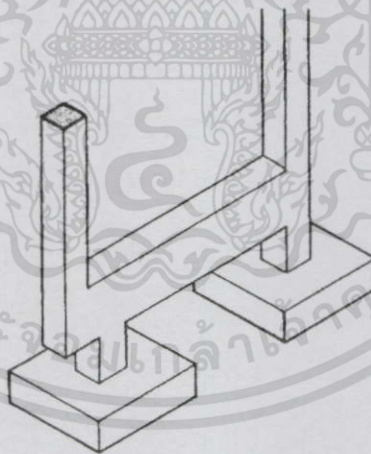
แสดง ฐานรากแผ่แบบยื่นหรือยึดร่วม (Cantilever or Strap Footings)
